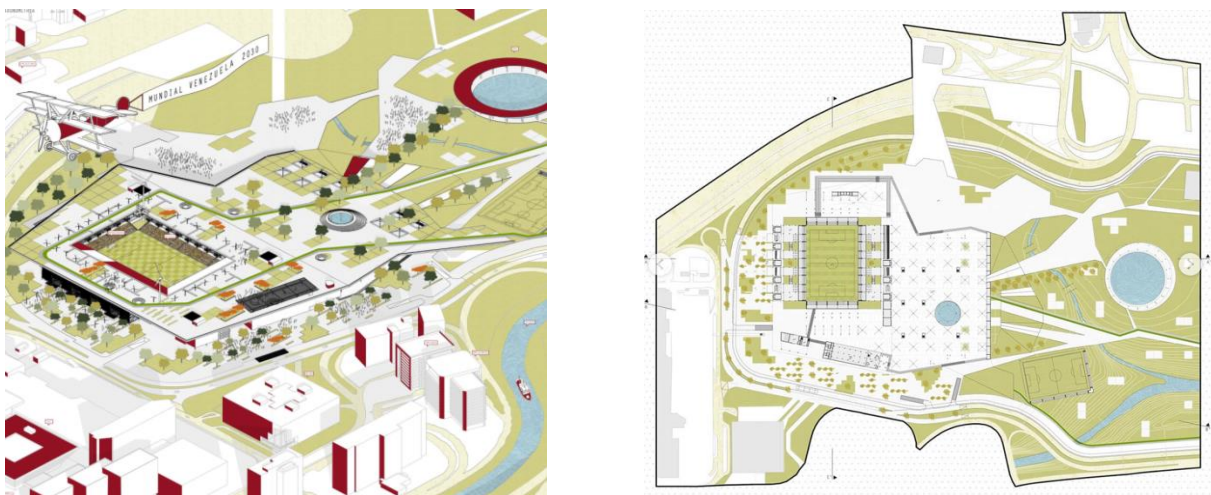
11. El Estadio de Caracas/Epicentro de Eventos Urbano, ubicado en Caracas, Venezuela. Vista 3D del conjunto/contexto y Planta baja conjunto. Elaborado por Ferrer, Q. Publicación en línea (2018).
